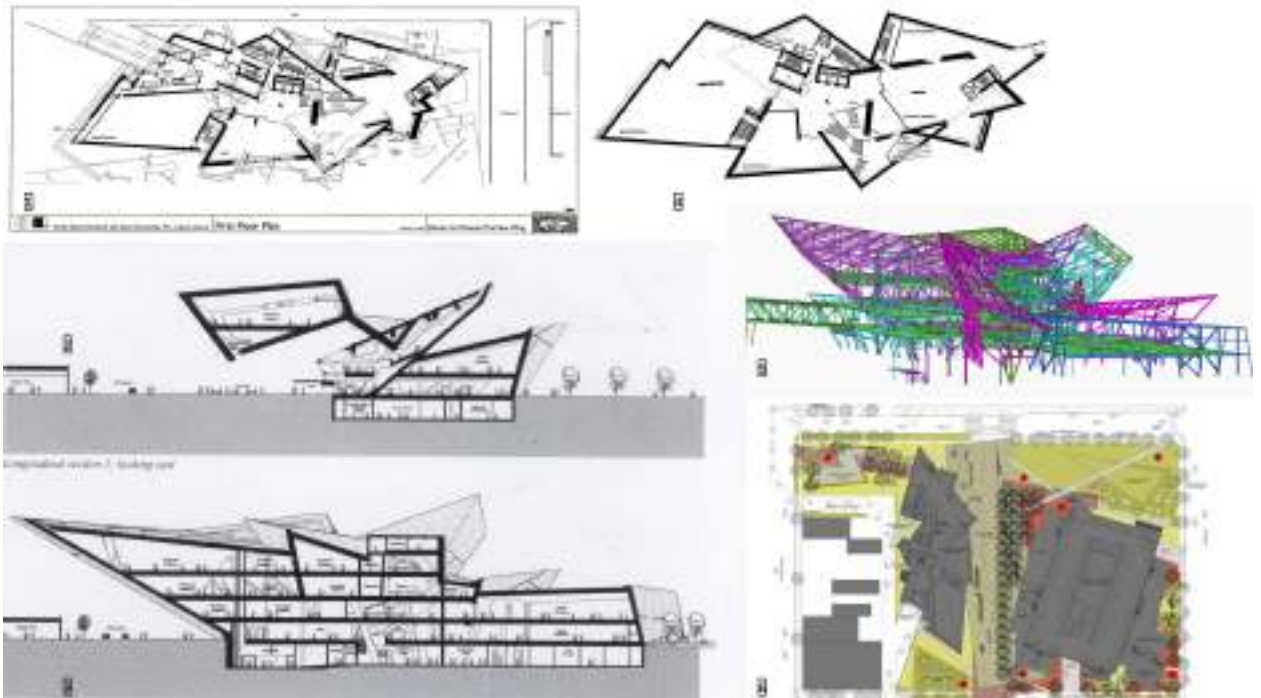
План першого поверху [33], Рис.2- Розріз повздовжній [34], Рис.3- Розріз поперечний, Рис.4- План другого поверху [35], Рис.5- Конструктивна схема [36], Рис.6- Генплан [37].
